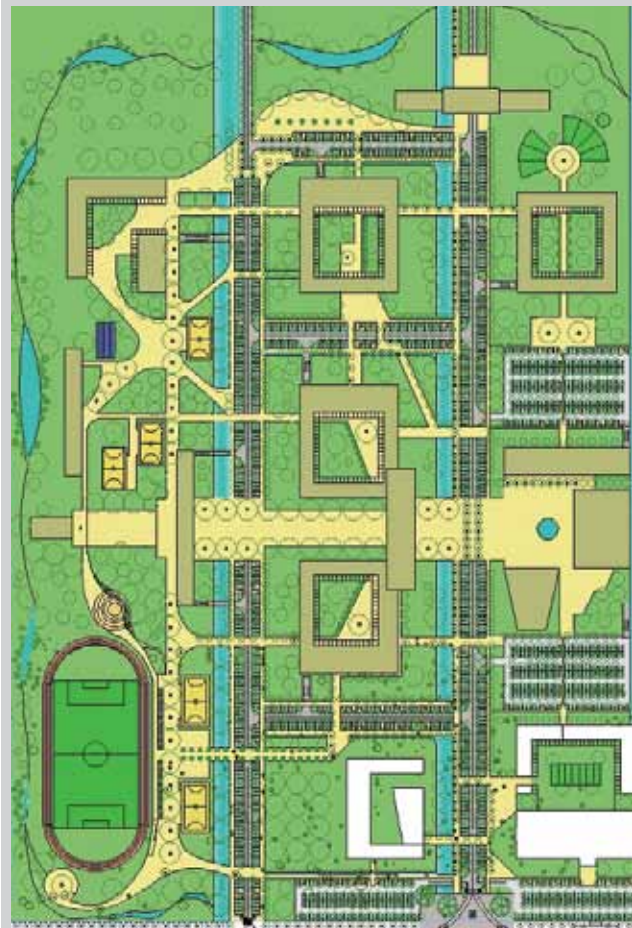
Campus Planaltina Universidad de Brasilia. Plan General. Pavimentos de peatones en amarillo; canales, en azul.
